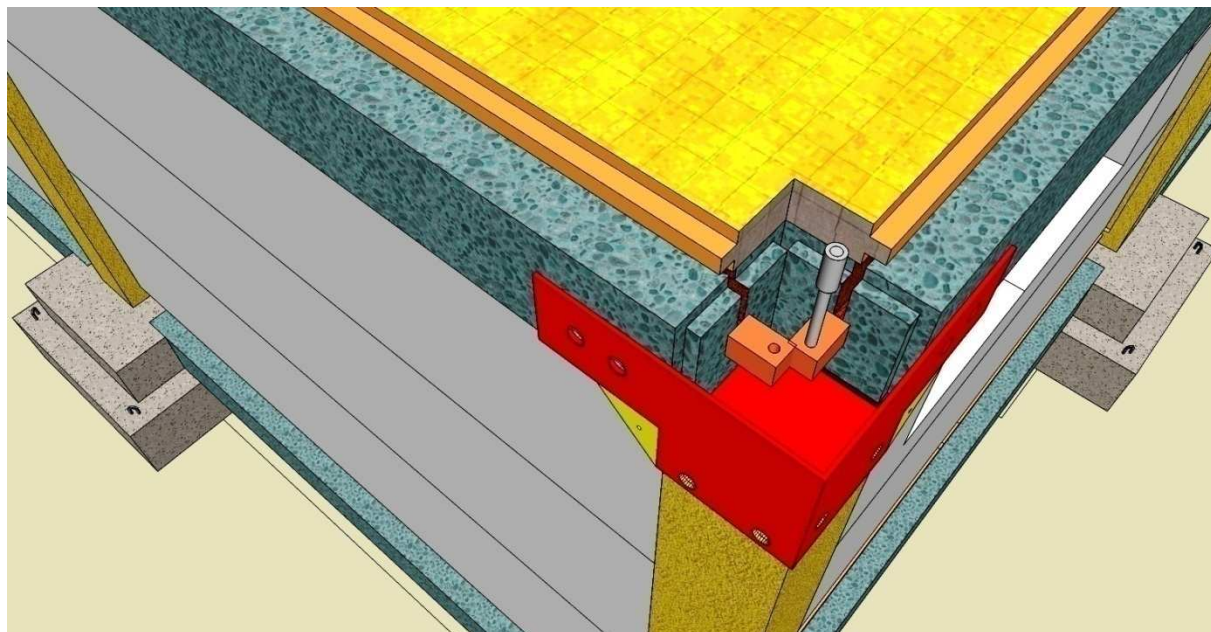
vue exposant l'assemblage des poutres de coin, dalle, nœud sur poteau
